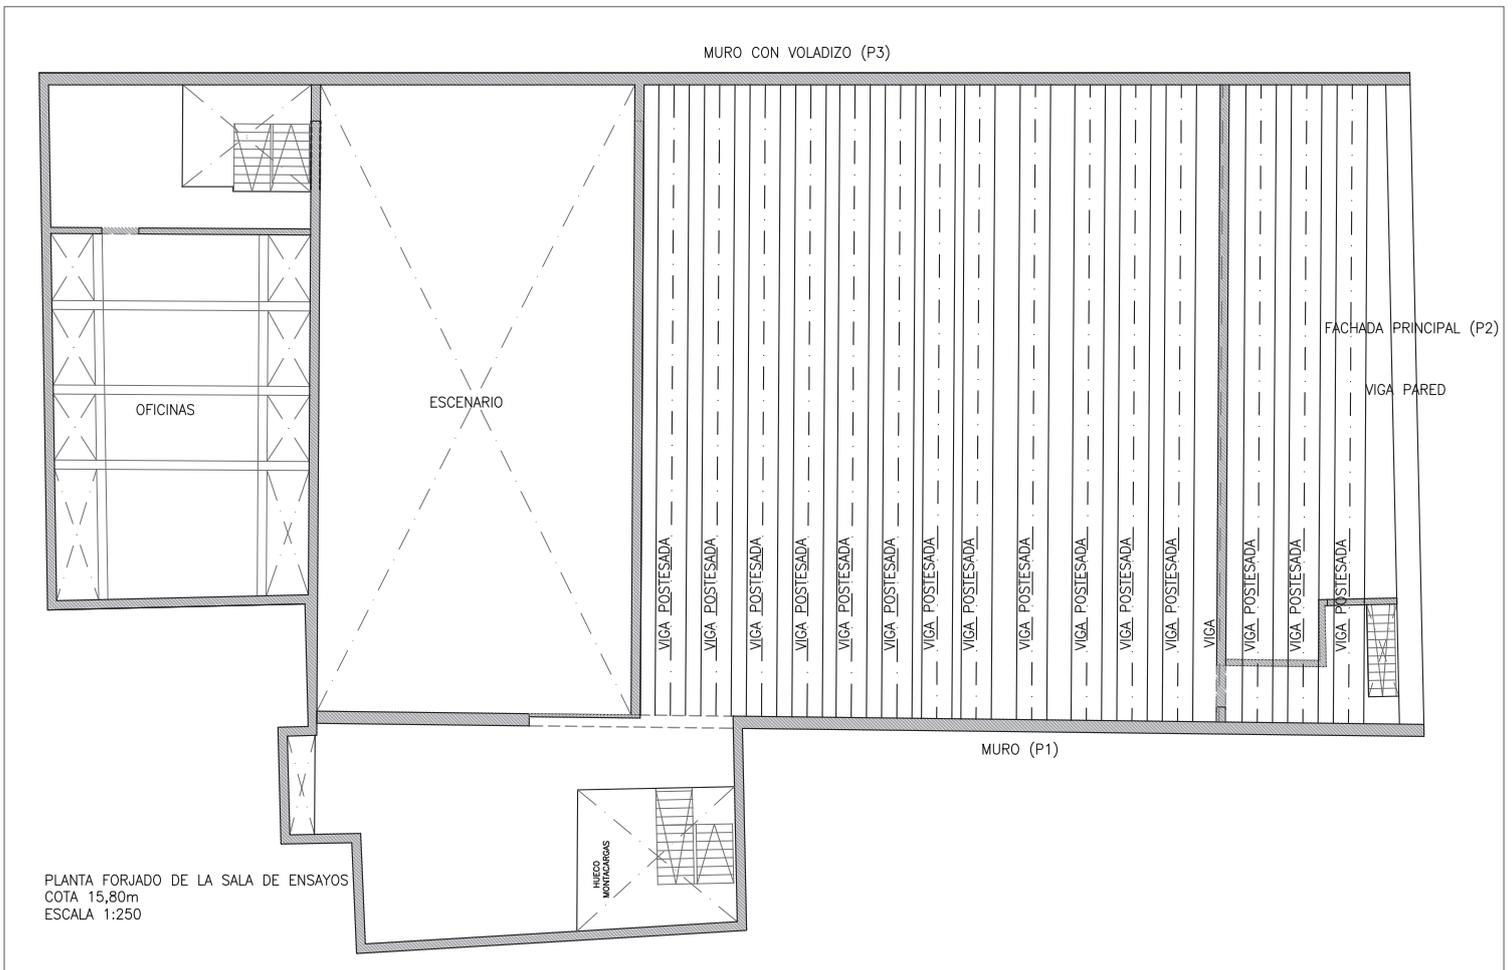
Planta del forjado de la sala de ensayos. Escala 1:250 [27]
